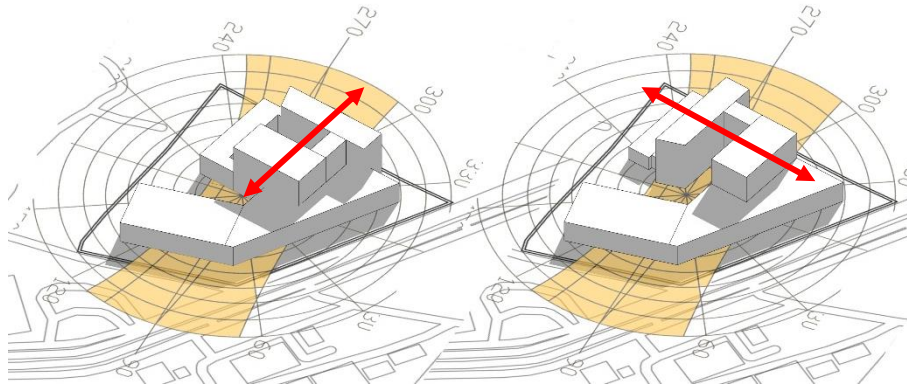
22 Zonasi Bangunan Berdasarkan Gubahan Massa
